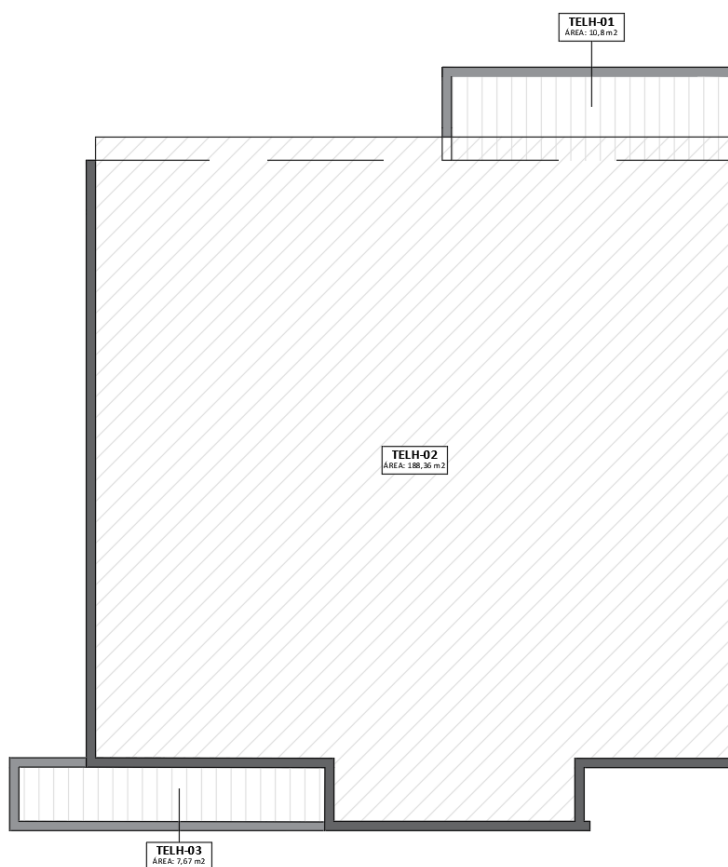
Planta com identificação da cobertura, ler em conjunto a planta de cobertura que compõe a pasta técnica da obra.
